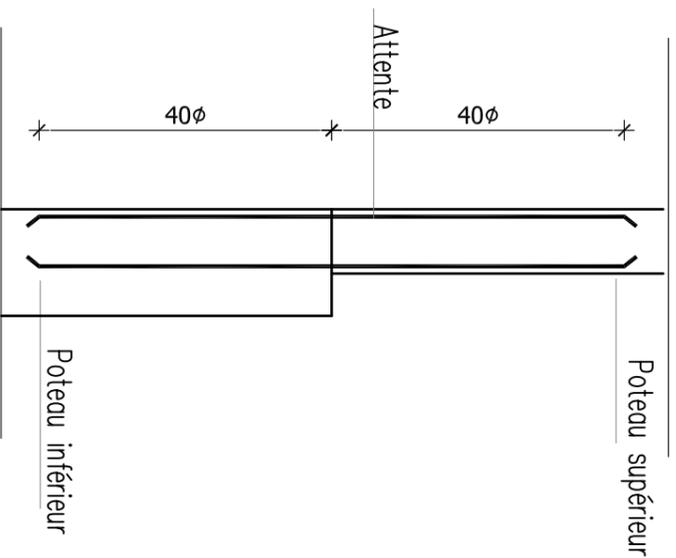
#### DETAIL ATTENTE POTEAU IMPLANTE: P21
